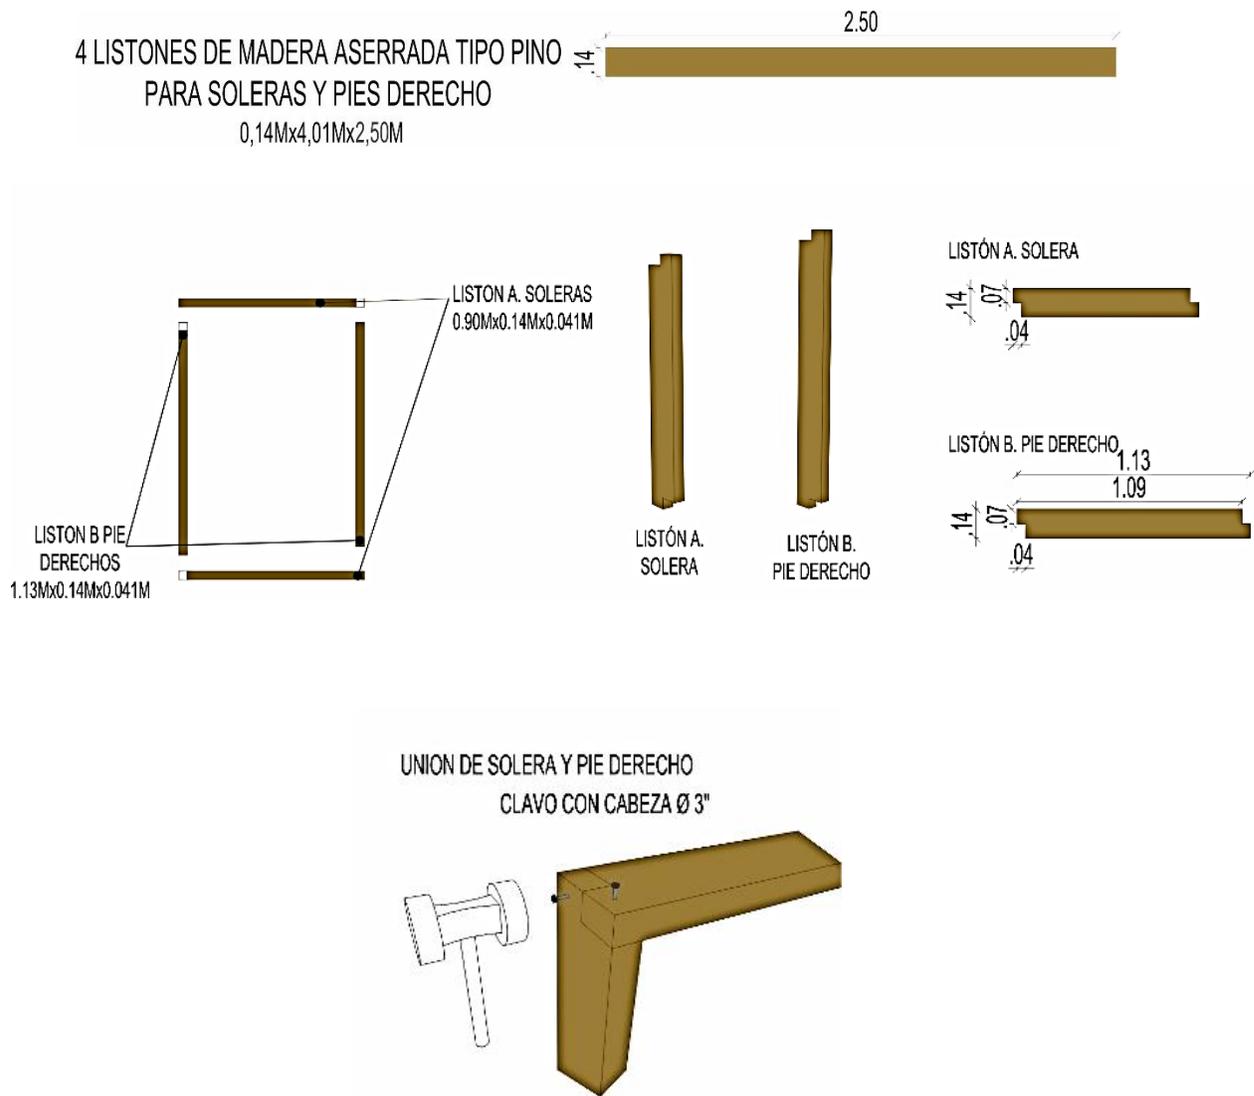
Detalle Constructivo de la parte inferior del muro.
